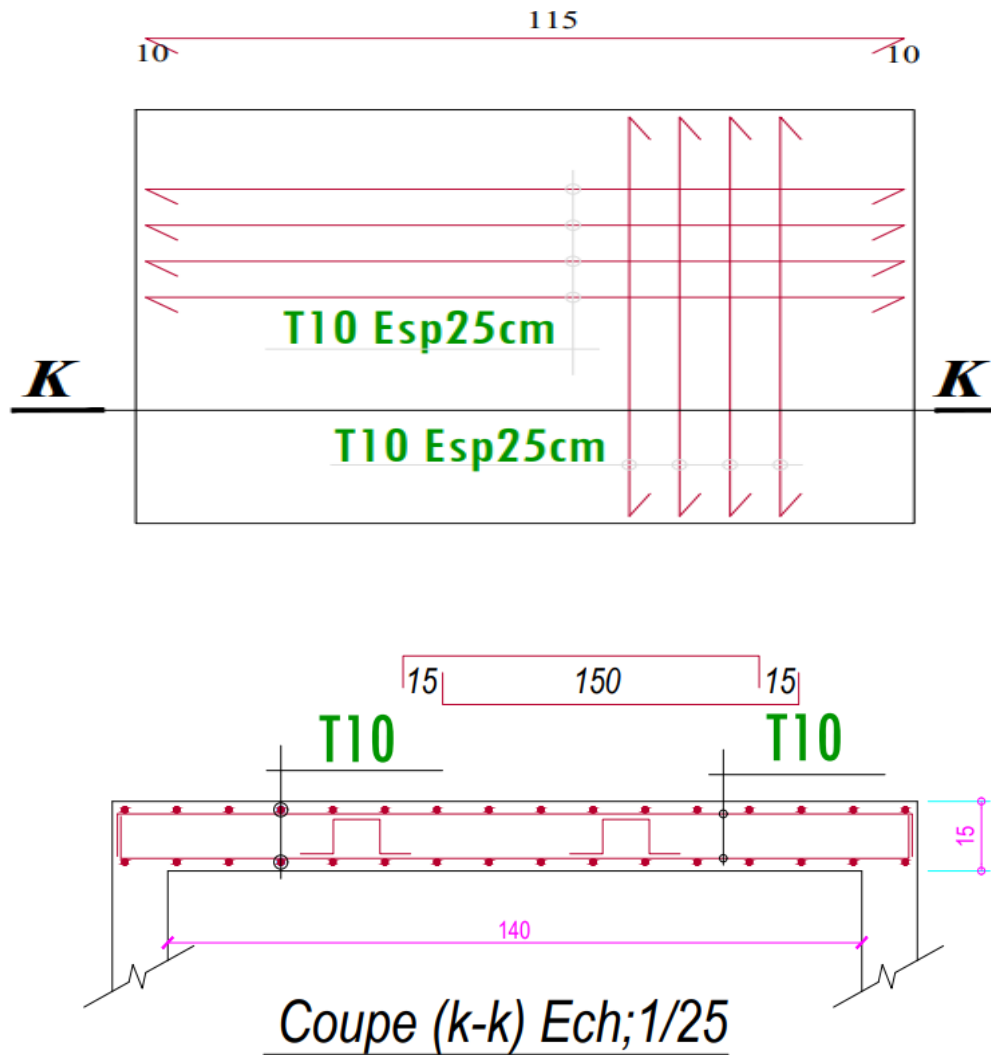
Ferrailage de la dalle de la gaine d'ascenseur
